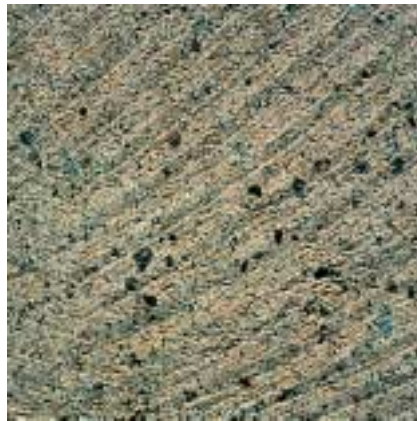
Gesägte Betonoberfläche, eingefärbt, weißer Zement
